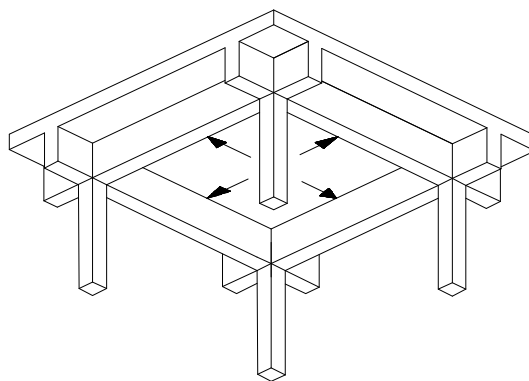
LOSA MACIZA APOYADA EN DOS DIRECCIONES
